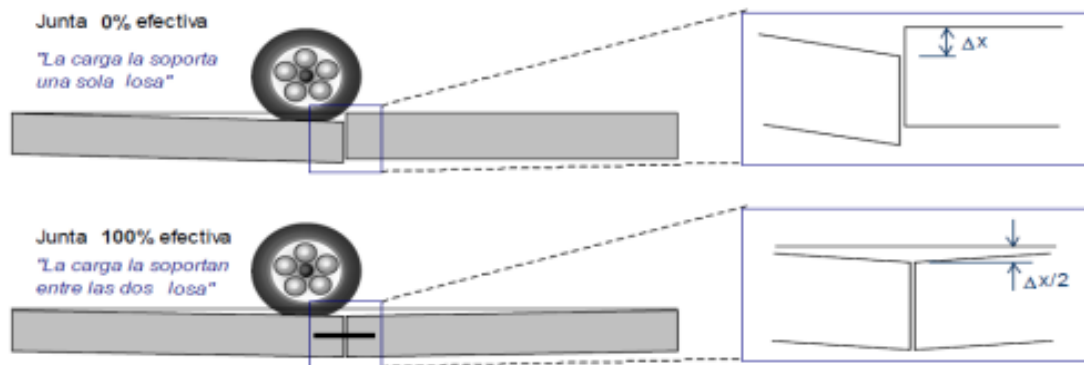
Comportamiento de una junta entre losas de concreto, por Lazcano, 2015.
